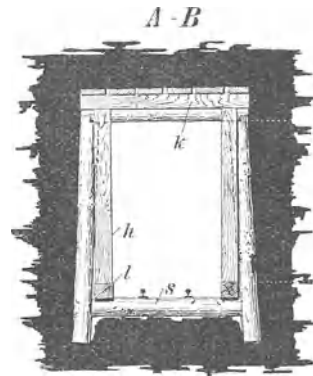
Verstärkte Türstockzimmerung mit Grundschwellen.
